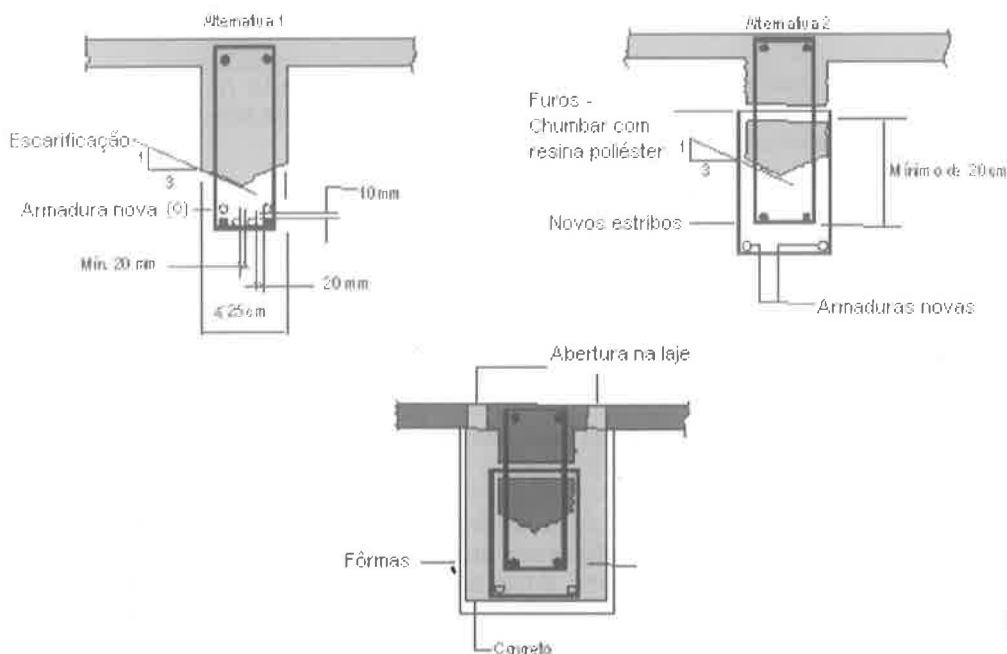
Reforço de flexão em vigas com concreto.
